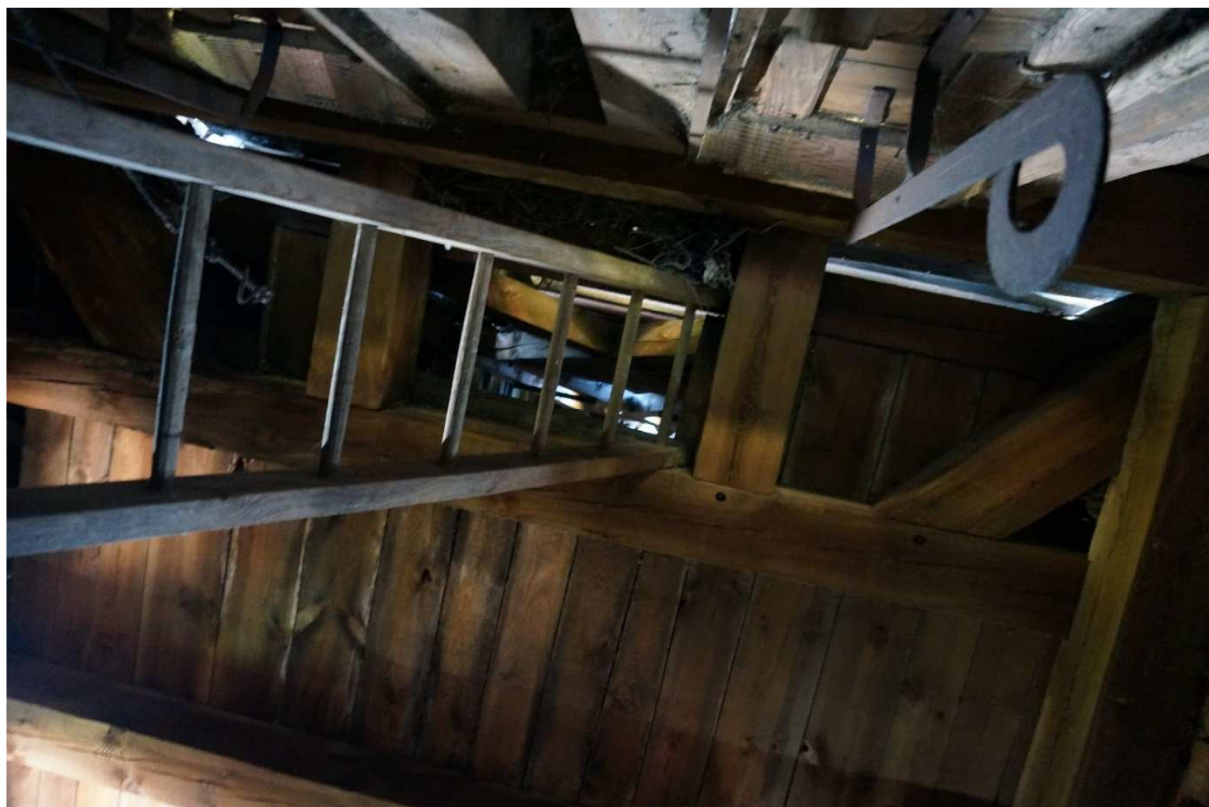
Widok ogólny na konstrukcję drewnianą wieży na poziomie więźby dachowej kościoła – widać, że konstrukcja wieży jest niezależna.
